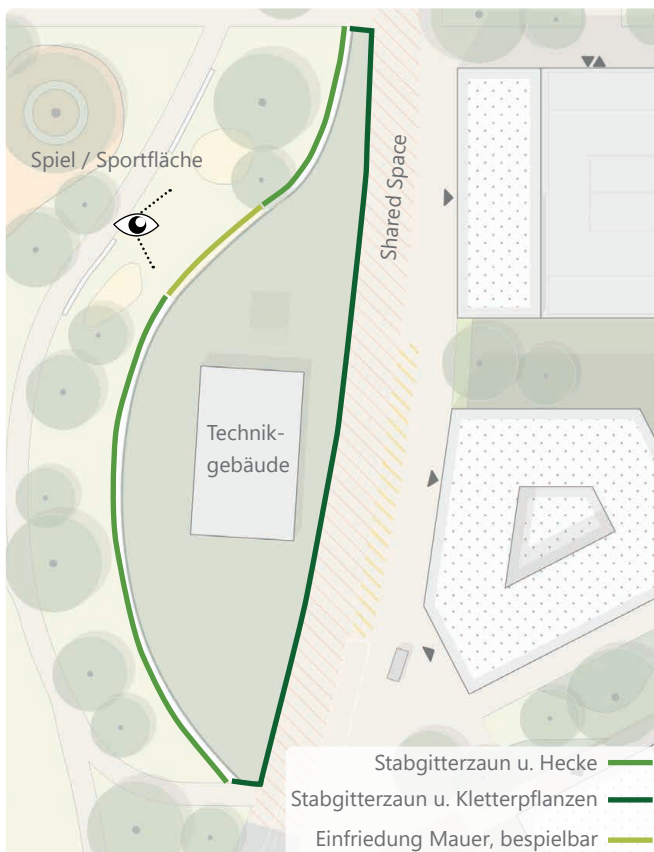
Lageplanausschnitt – südliches Technikgebäude
